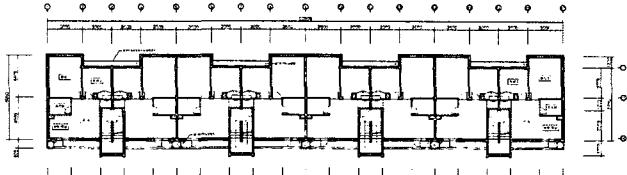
분별해체 시험시공 대상 아파트 기준층 평면도
